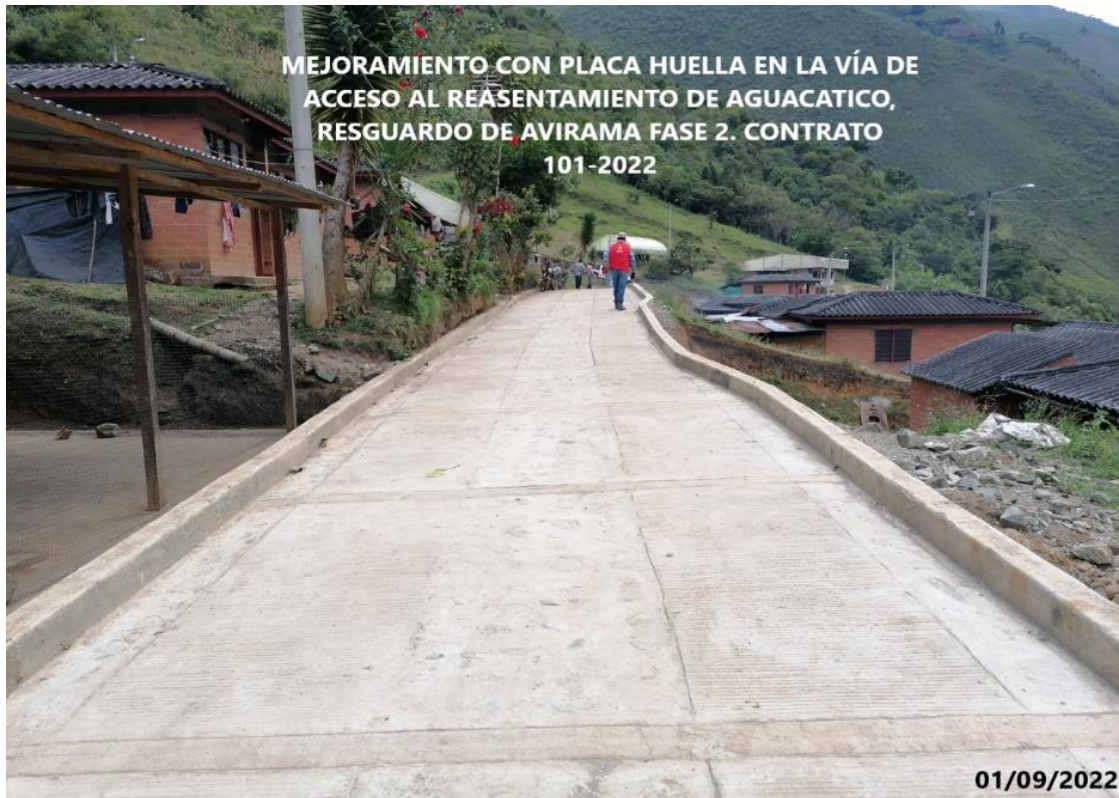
Inspección a las Placas-huellas construidas por la CNK vigencia 2022, Páez Cauca.
